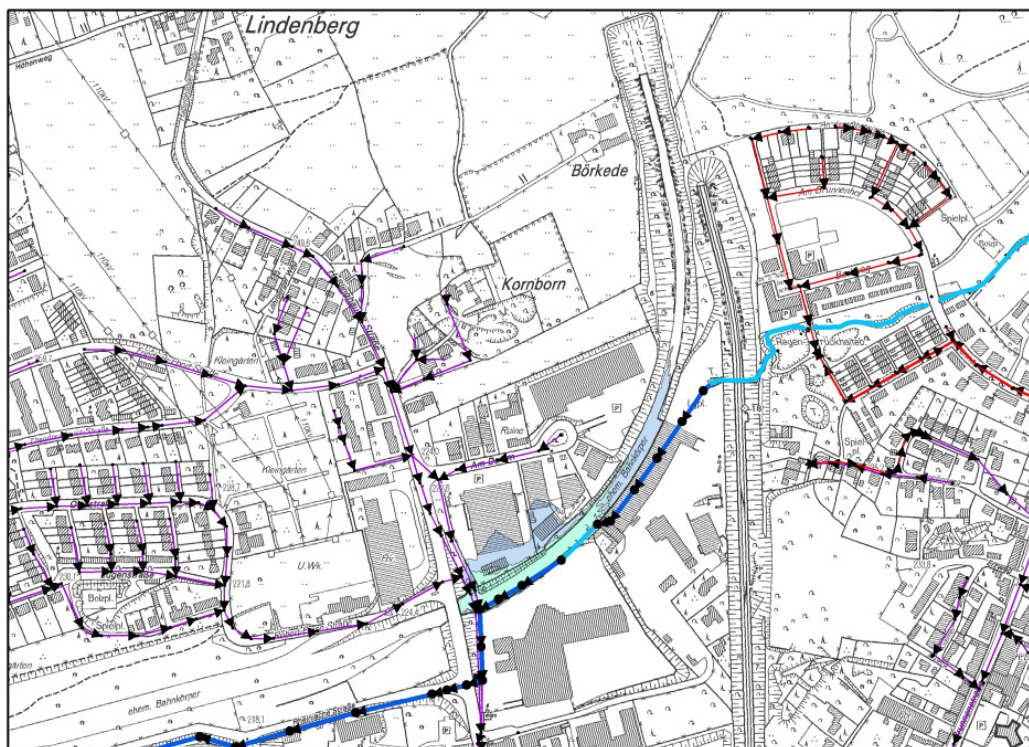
Planungsbereich Prinzenstraße (Lageplan)
